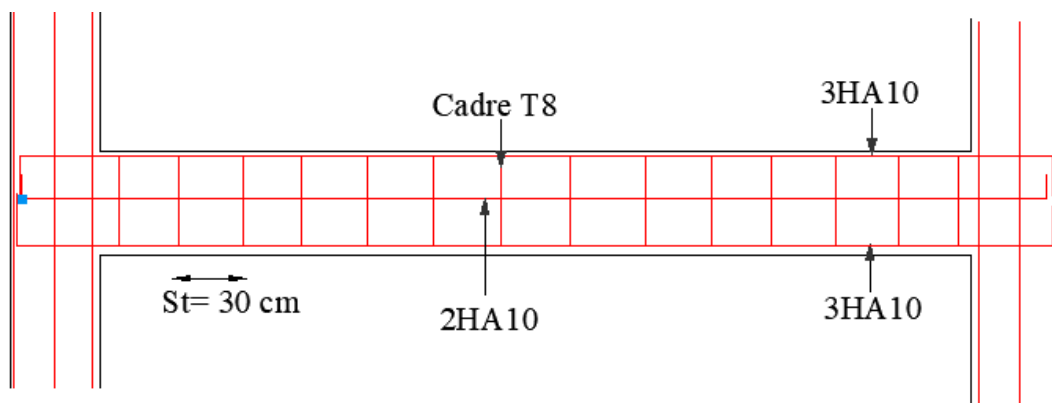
Ferrailage de poutre palière (escalier 1).
